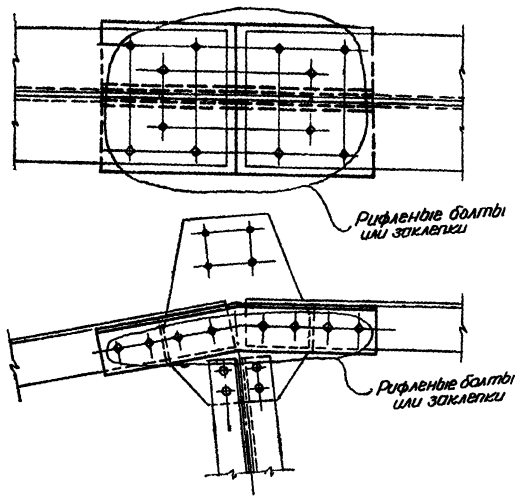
Пример решения стыка нижнего пояса сварной фермы при ширине полок уголков 130 мм и более
